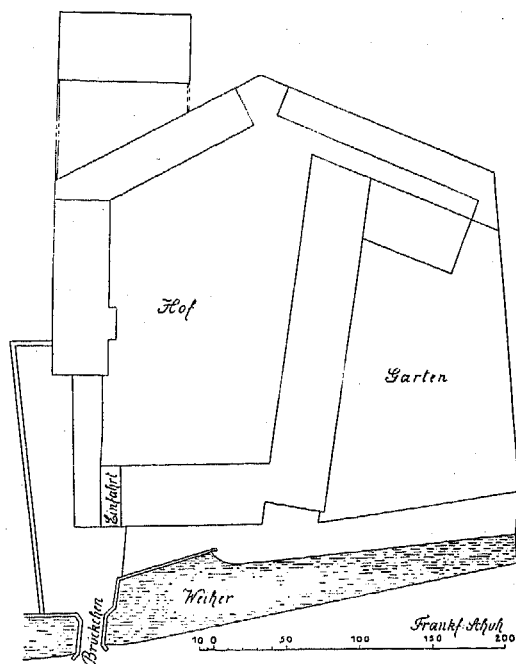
Hof Rebstock; Grundriss im Jahre 1845. Nach Akten des Bauamtes.
